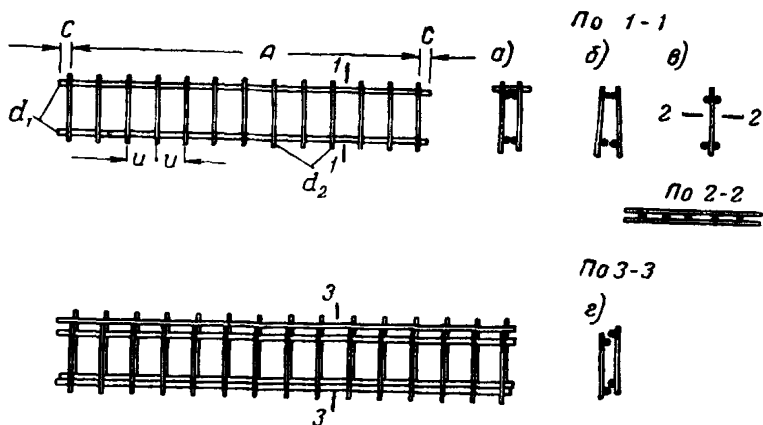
Типы сдвоенных каркасов балок, изготовленных из плоских сварных каркасов, приведенных на рис. 7, а; а, б, в и г — различные варианты сочетания плоских каркасов
